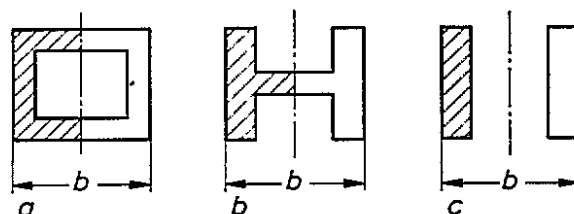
Druckzonen bei aufgelösten Grundrißformen von Flächenfundamenten
